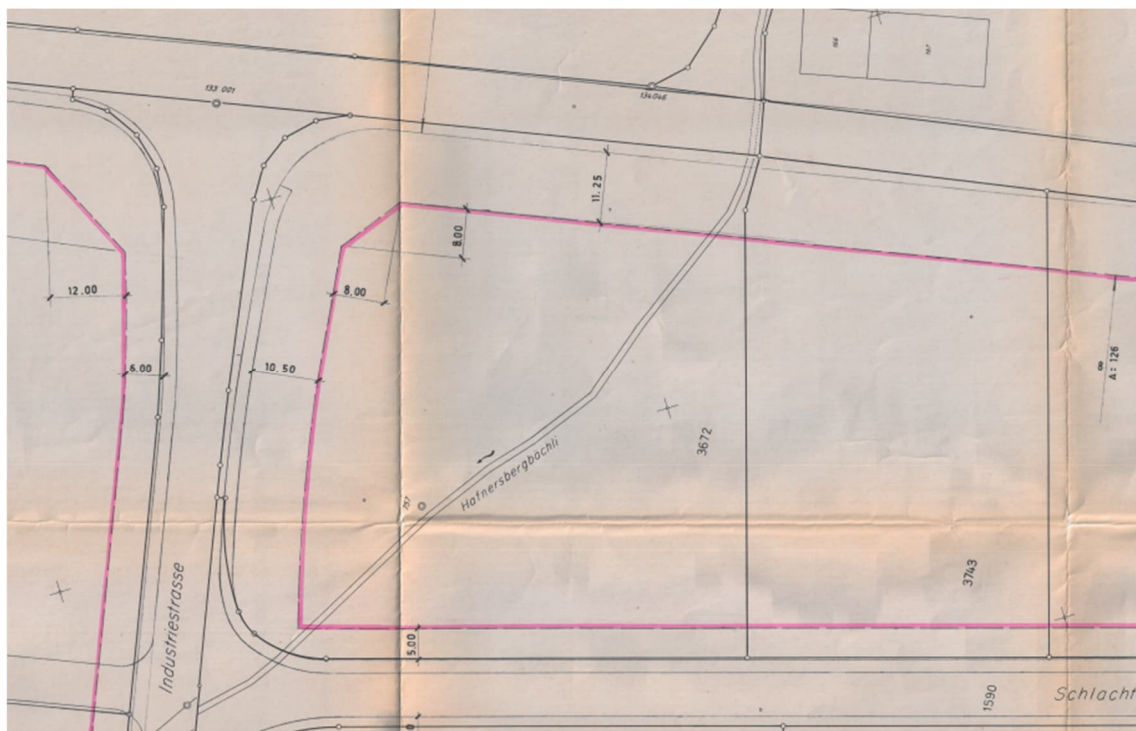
Ausschnitt des Überbauungsplans mit besonderen Vorschriften Industriestr./Schlachthofstr. Plan-Nr. 4
